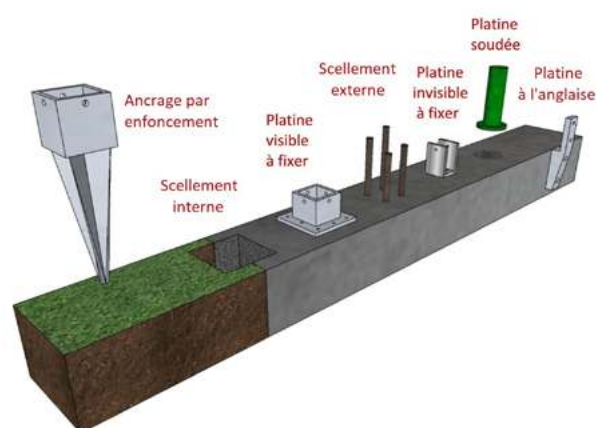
schéma des systèmes de fixation de poteaux les plus courants (dessin de Cédric Houel).
